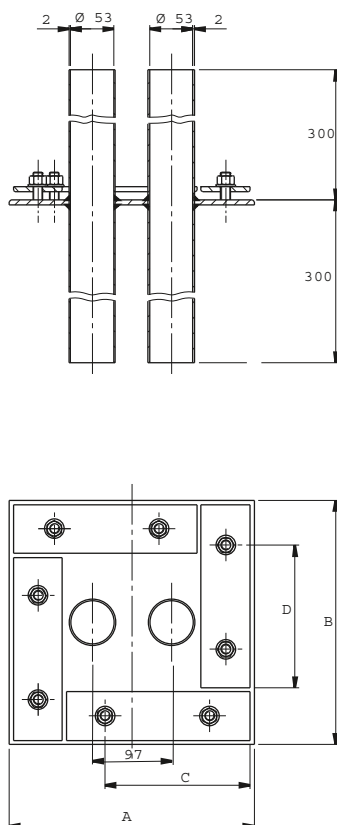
Rohrdurchführungen mit zwei Hüllrohren aus nicht rostendem Stahl
